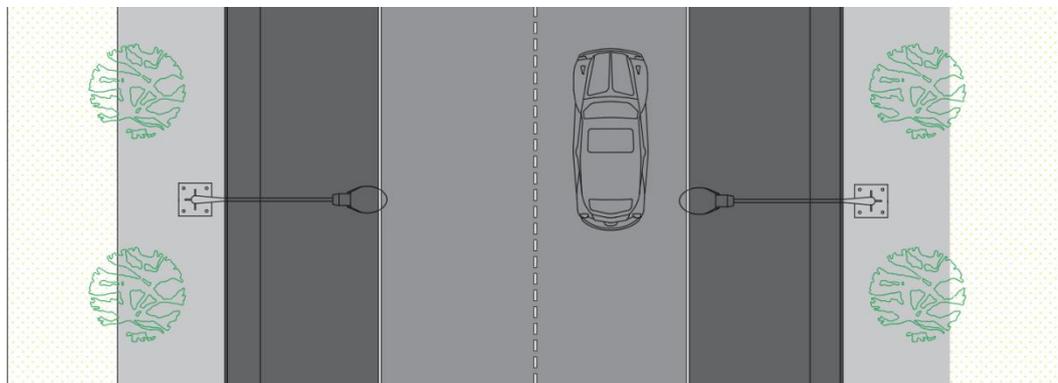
Vista en planta de la vía. Fuente: propia.
